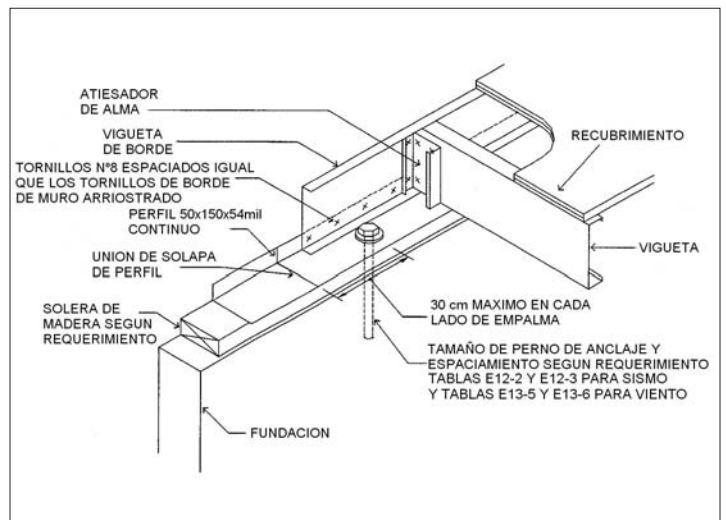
Conexión de Piso a Fundación de Muro Arriostrado con Solera de Madera
